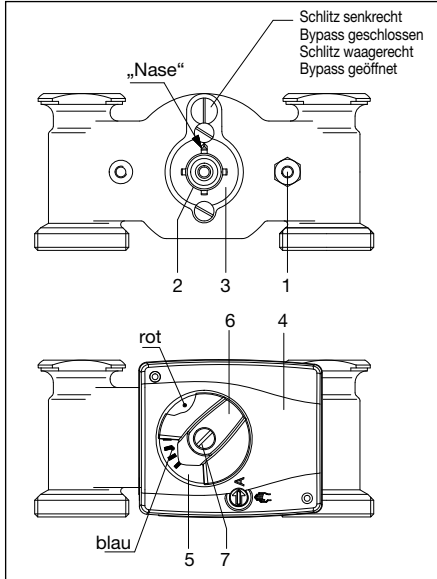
Montage 4-Wege-Mischhahn DN25 / DN32
